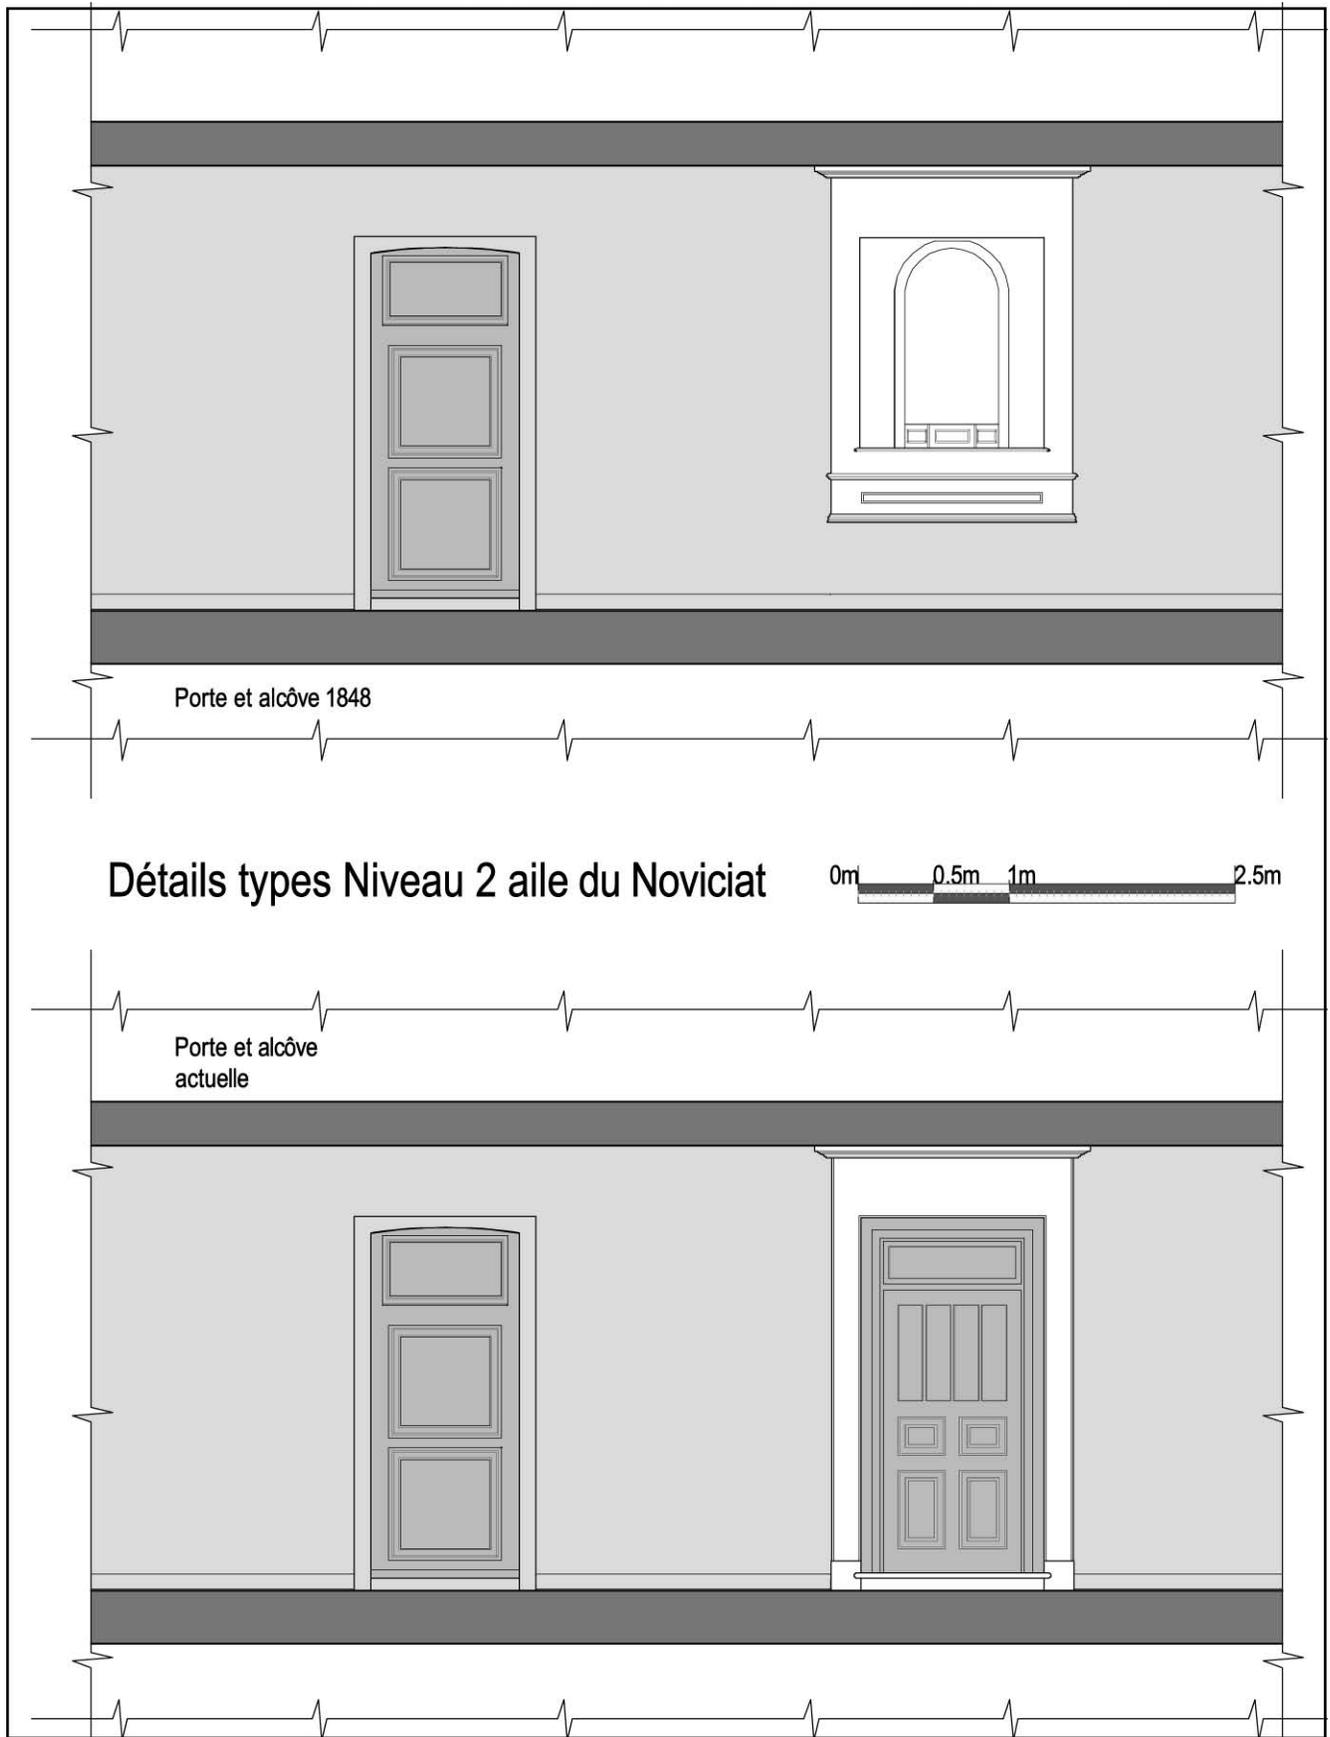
Détail de l'élévation d'un oratoire et d'une porte, reconstitution de la situation en 1848, détail de l'élévation d'un oratoire et d'une porte, situation actuelle en 2007
